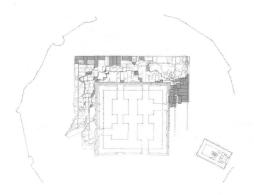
Planta del perímetro exterior de la torre romana obtenida por excavación arqueológica
